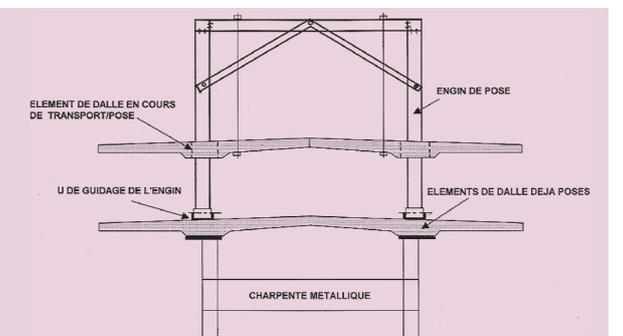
Principe d'un engin dédié à la pose d'éléments préfabriqués de pleine largeur (cas d'un roulement sur les dalles déjà posées)
